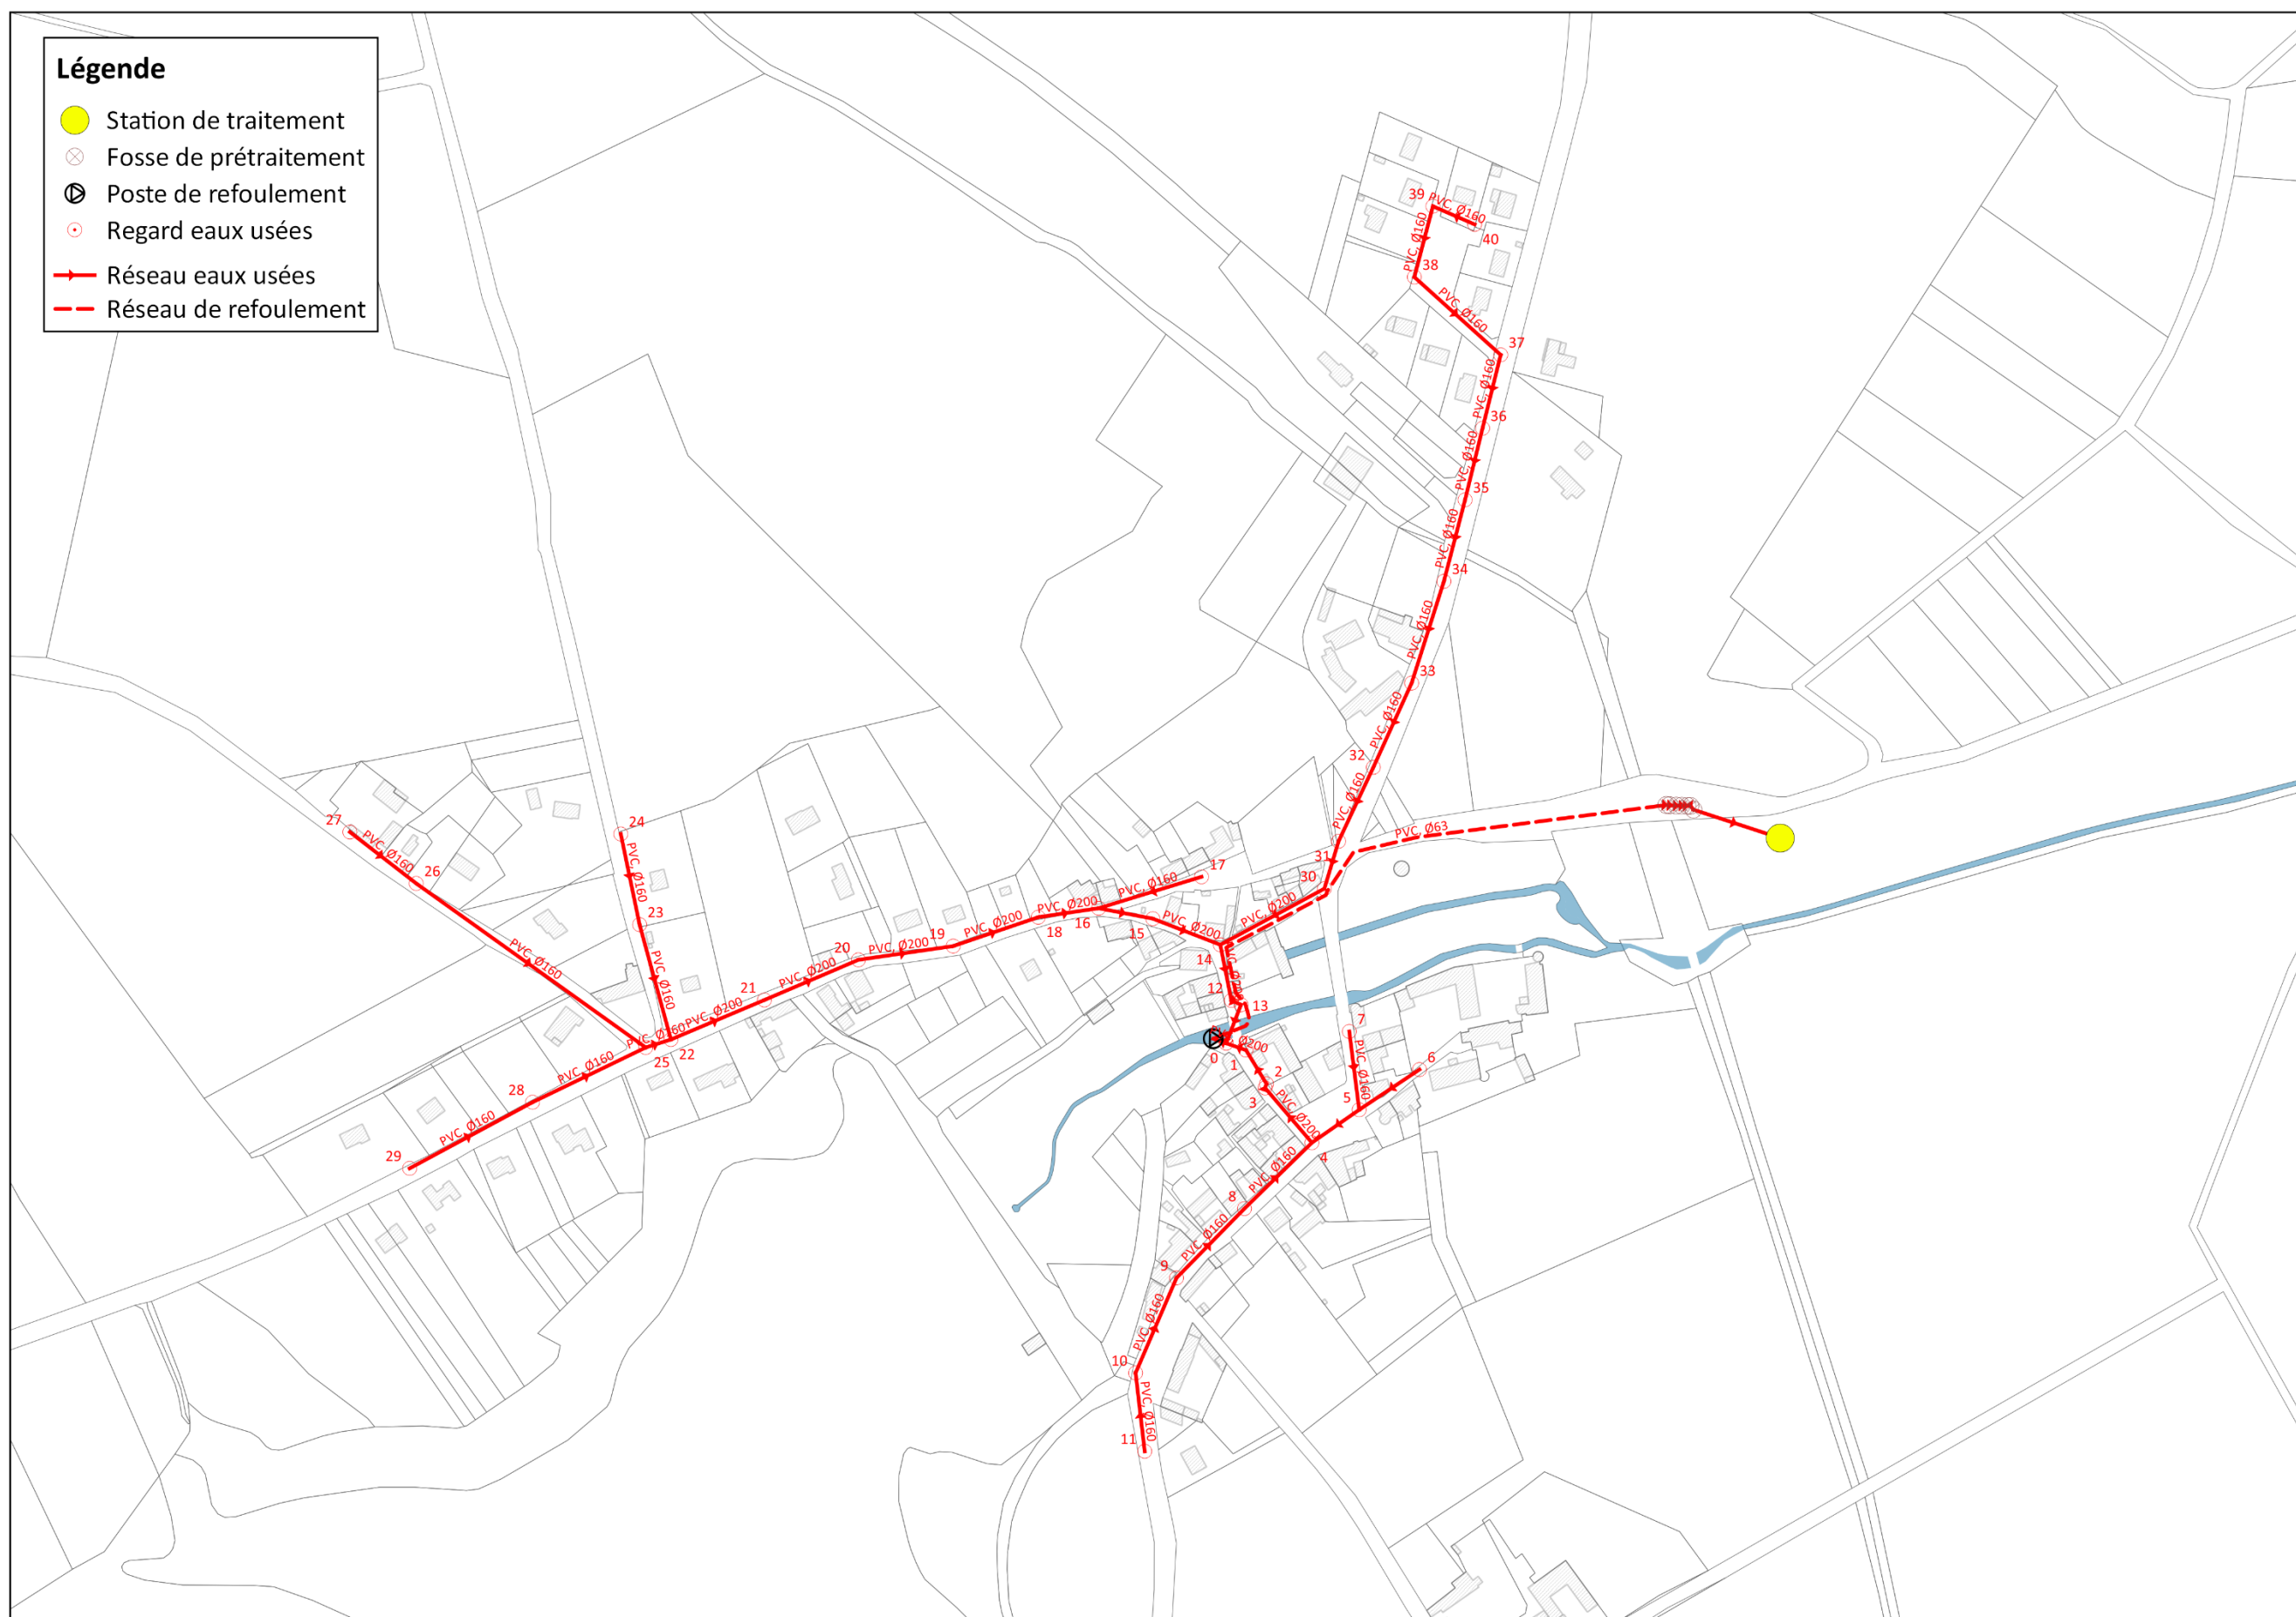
Plan du réseau d'assainissement collectif de la commune du Louroux
